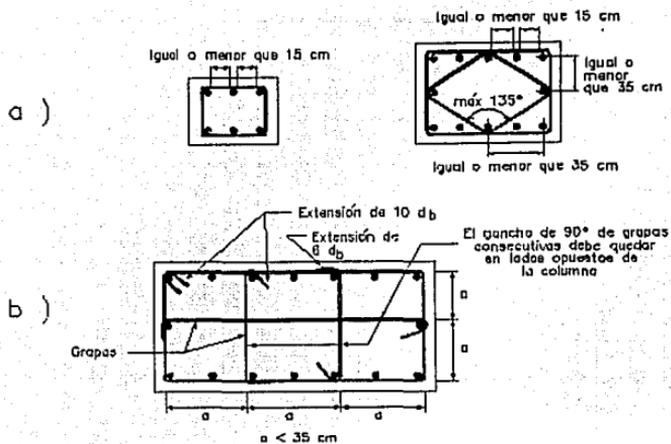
Detalle del refuerzo transversal en una columna nueva.
